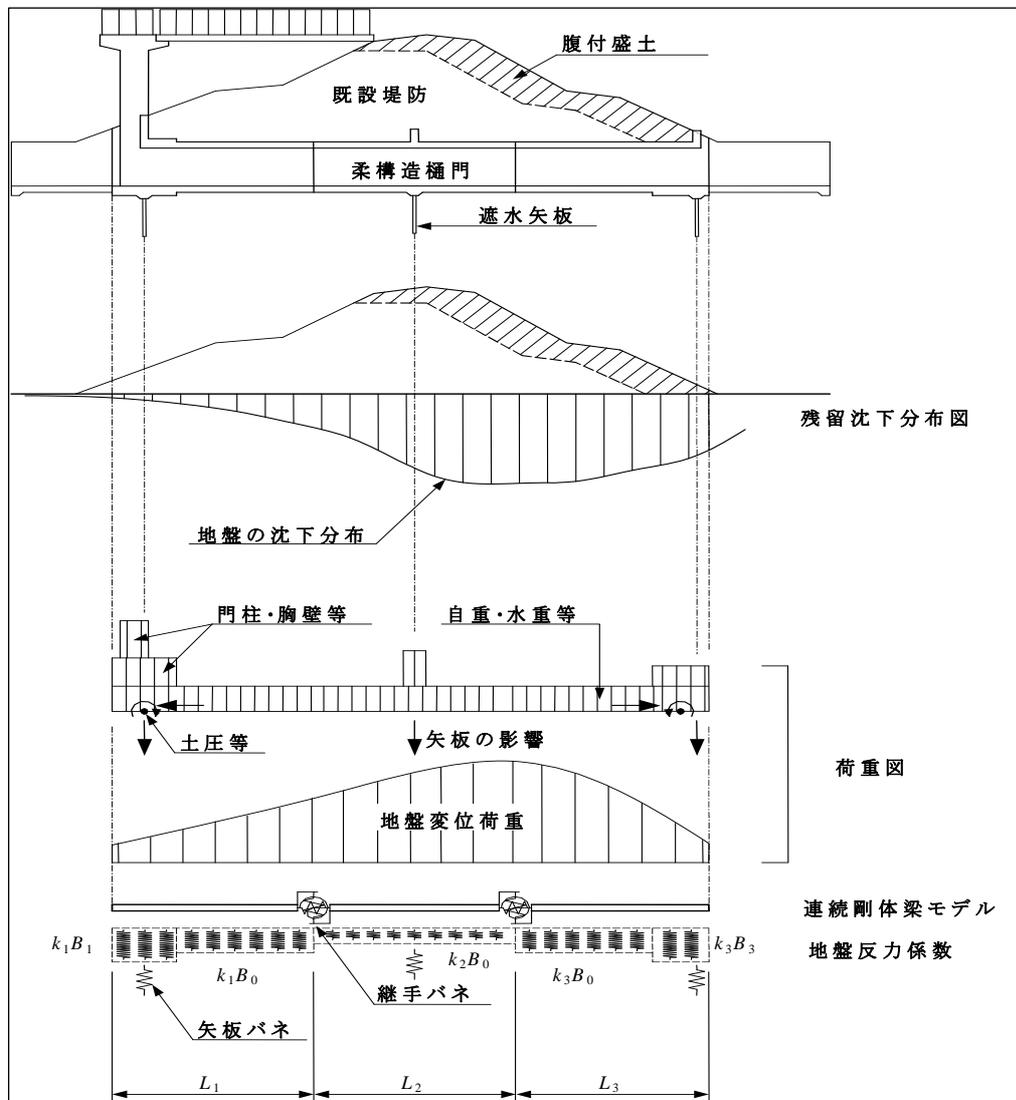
柔構造樋門の縦方向の設計モデル（弾性継手の場合）
